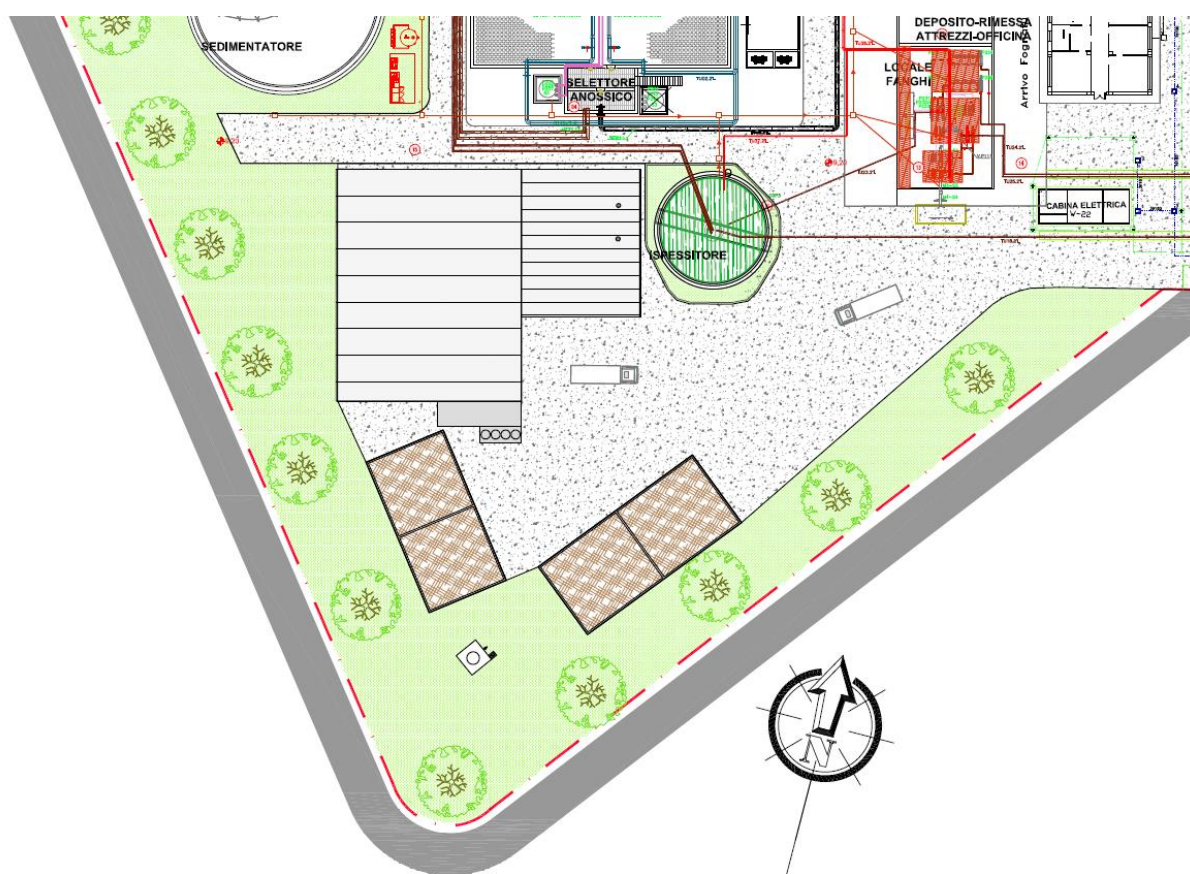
Planimetria della nuova sezione fanghi presso l'impianto di depurazione Basso Tenna CIIP spa
